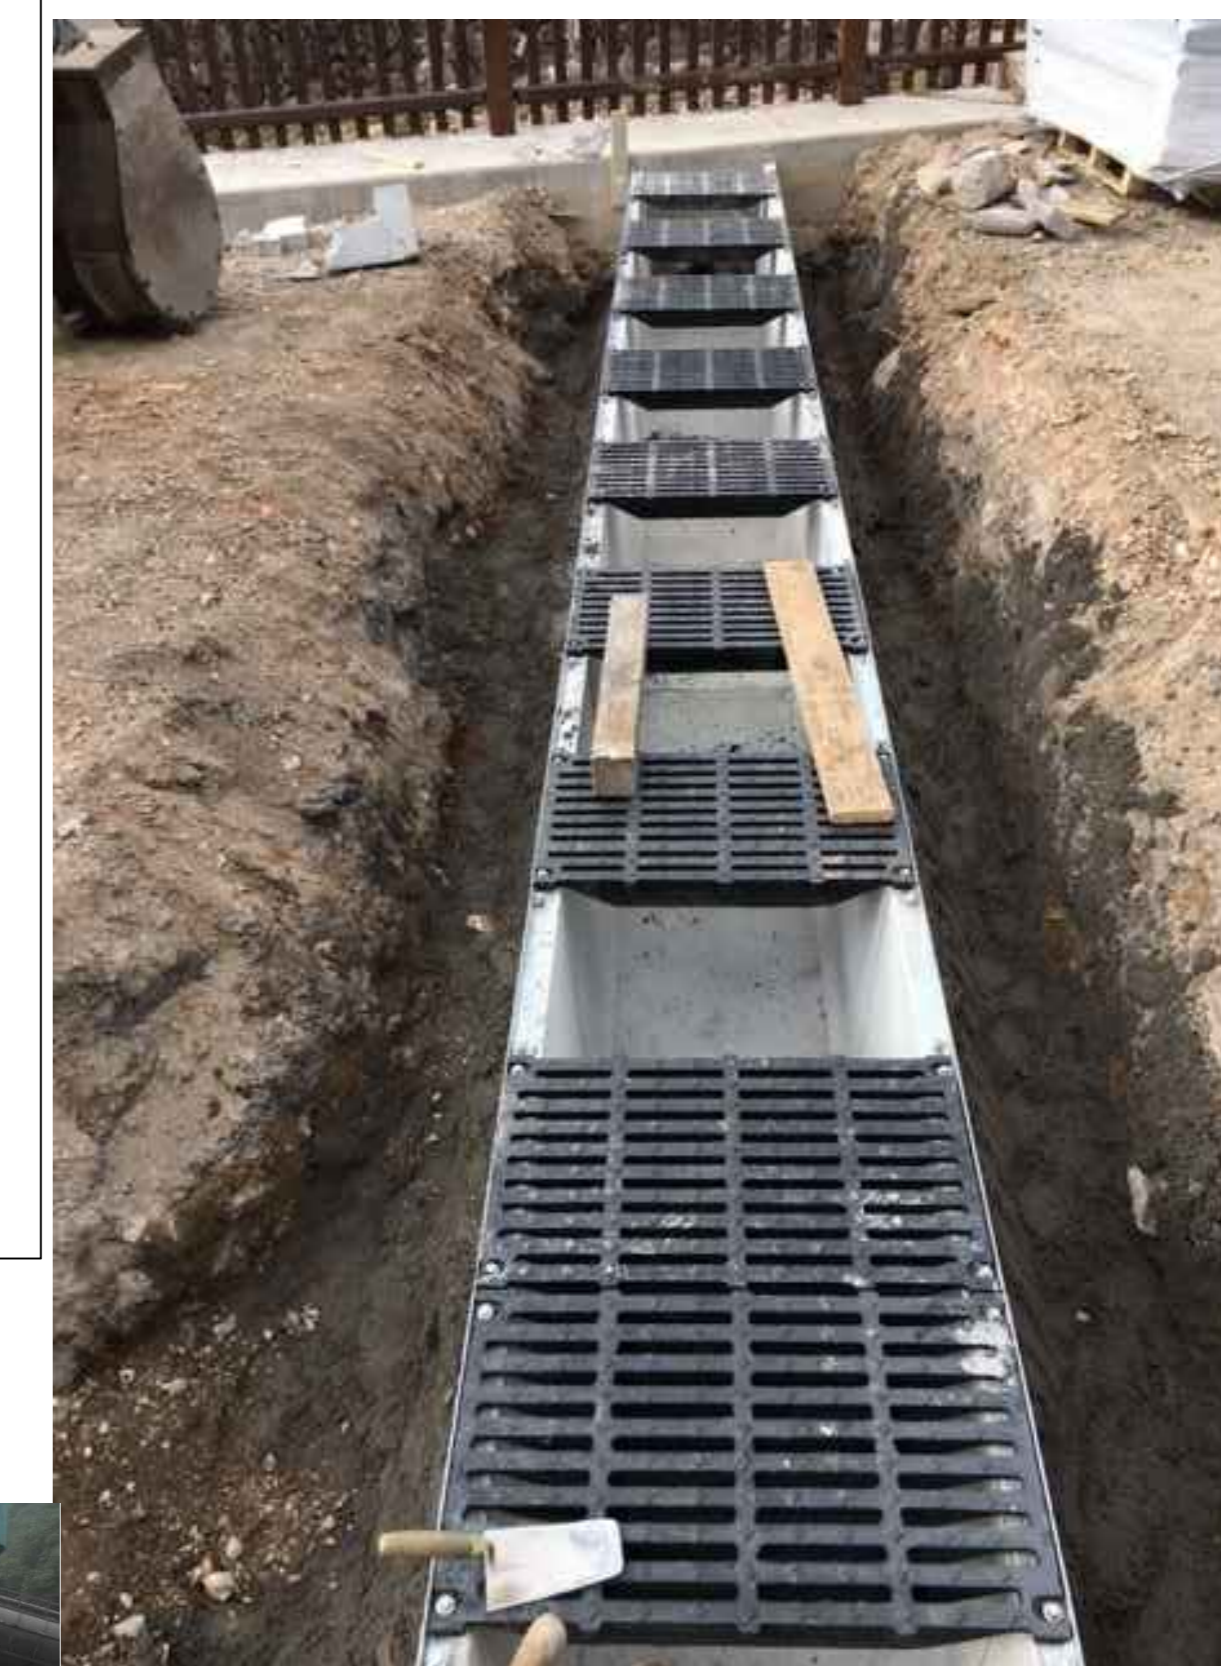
FOTO TIPOLOGICA - CANALETTA RETTANGOLARE 40 X 40 cm
